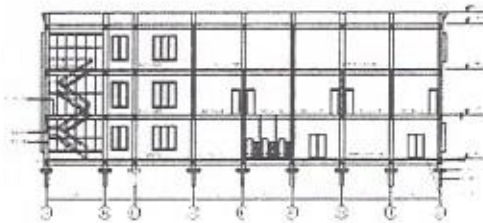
Bangunan tipe gedung bertingkat, untuk gedung pelatihan NTC.
